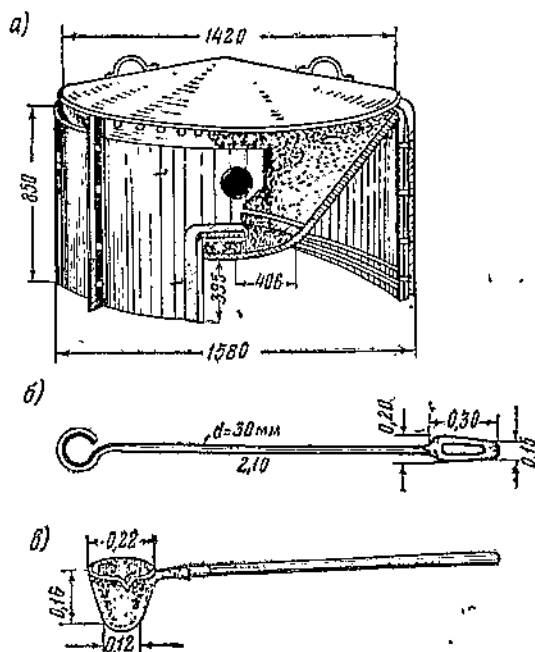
Открытый котел с крышкой для варки вижущего и мастики.
